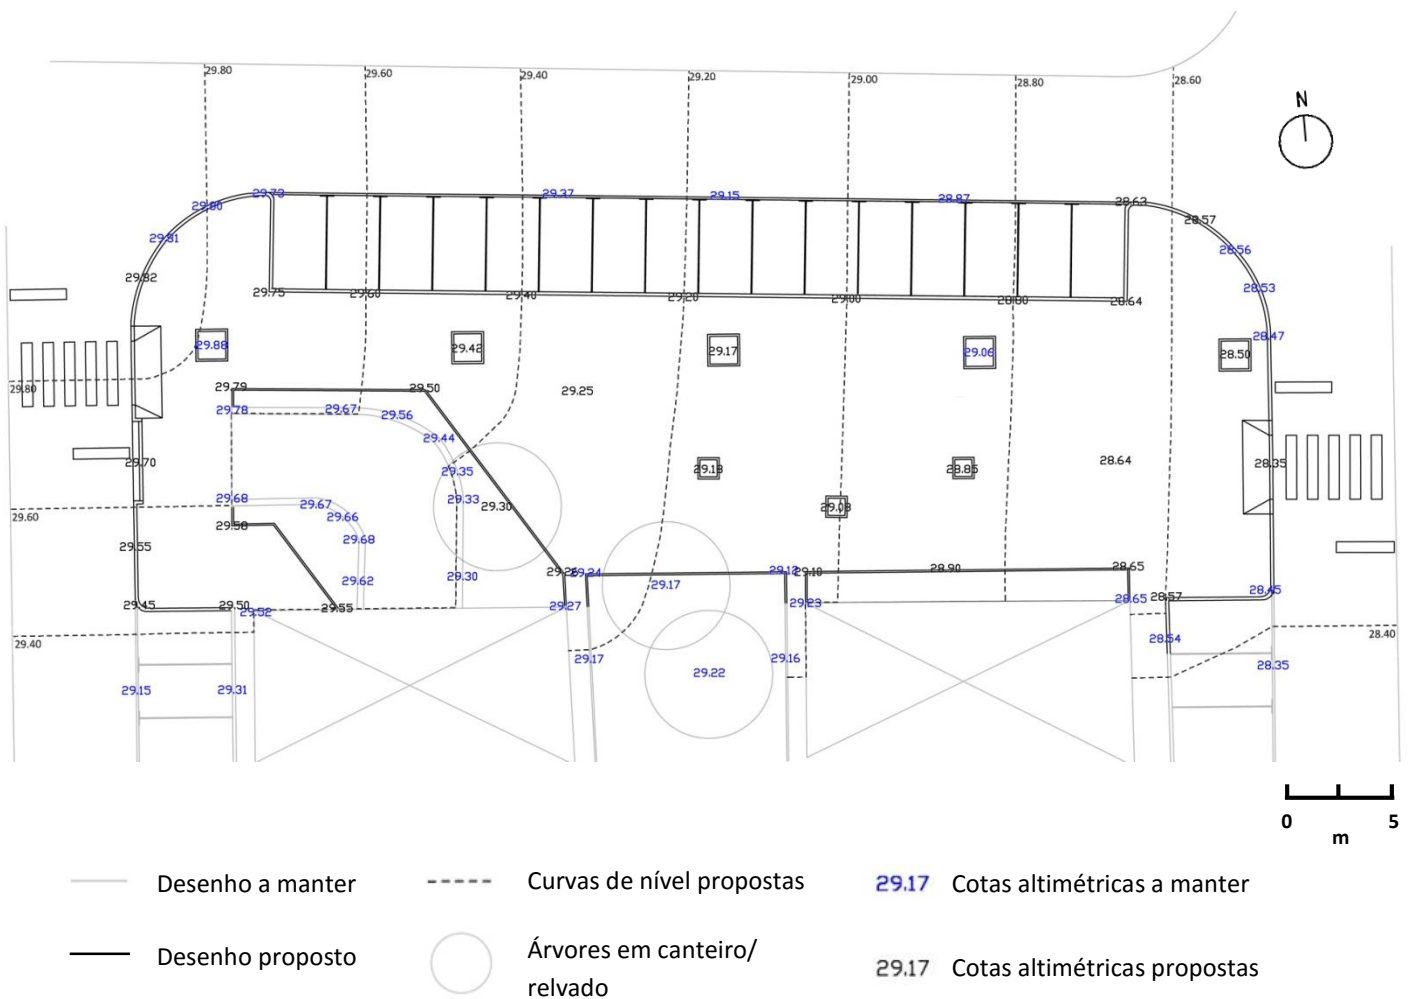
Planta da altimetria proposta para a praça (Fonte: autora do trabalho)
